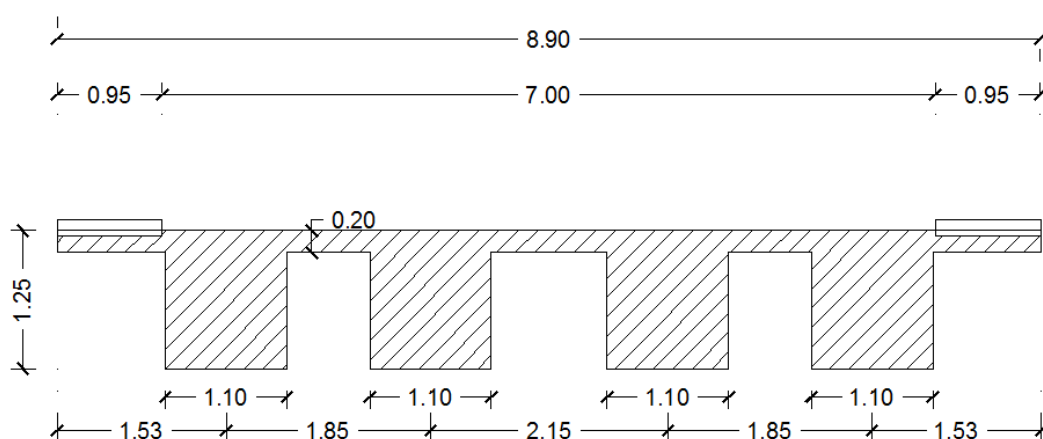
Secção transversal da ponte para a zona correspondente aos apoios. Adaptado de Jacinto (2011)
